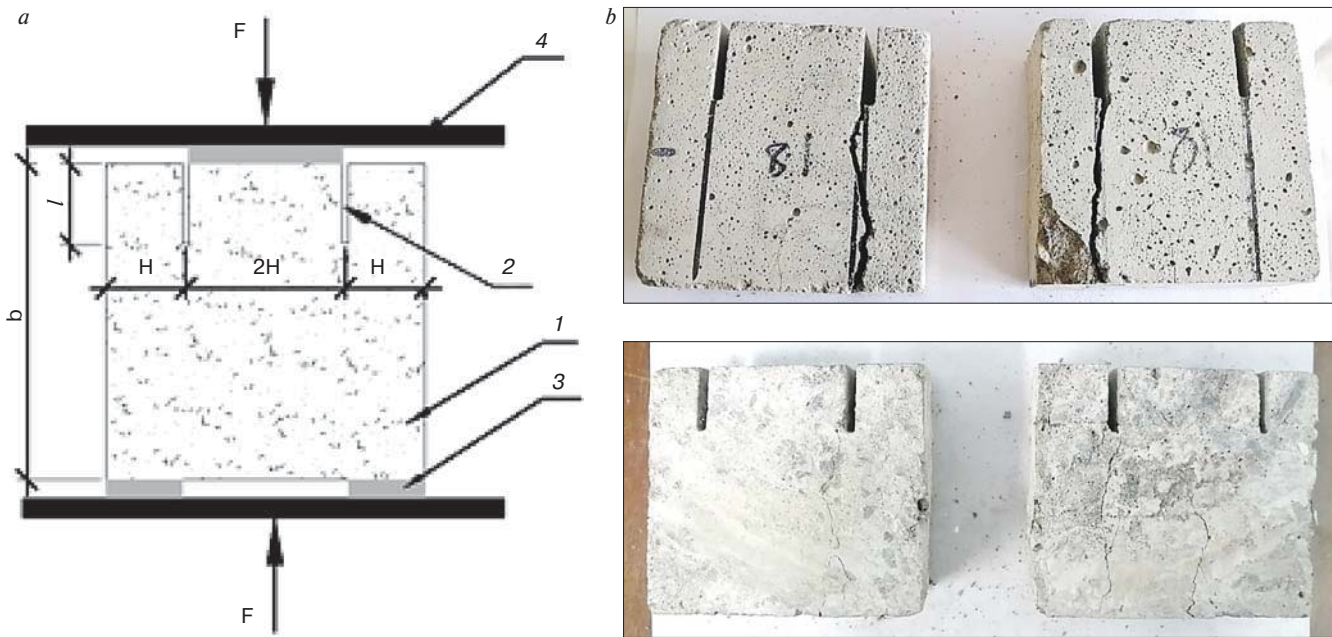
Схема нагружения образца для расчета K_{IIc} [11] – а; 1 – изделие; 2 – надрезы; 3 – металлические пластины; 4 – плиты пресса; b – высота образца; H – ширина плеча; l – глубина надреза; F – нагрузка, действующая на образец в процессе испытания; образцы после испытаний – б
